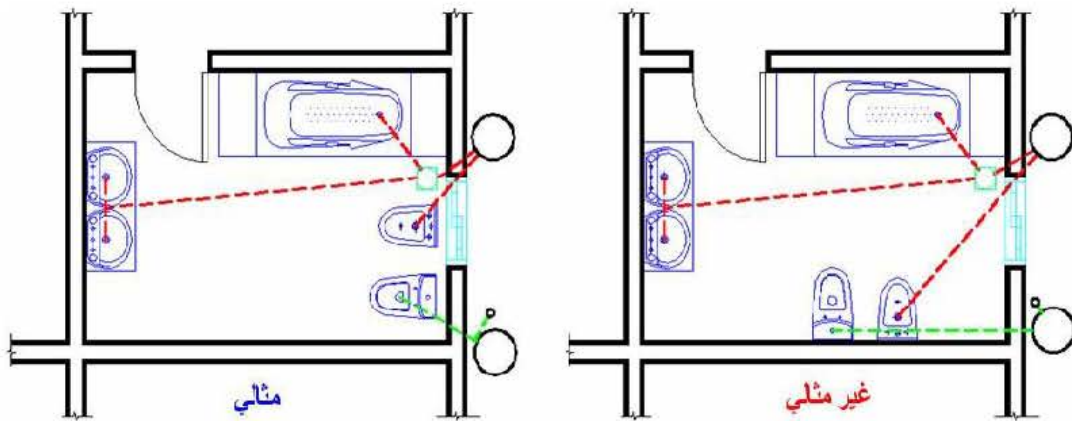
يوضح مسقط أفقي لدور أرضي به توحيد فرش الأجهزة لتسهيل الصرف
